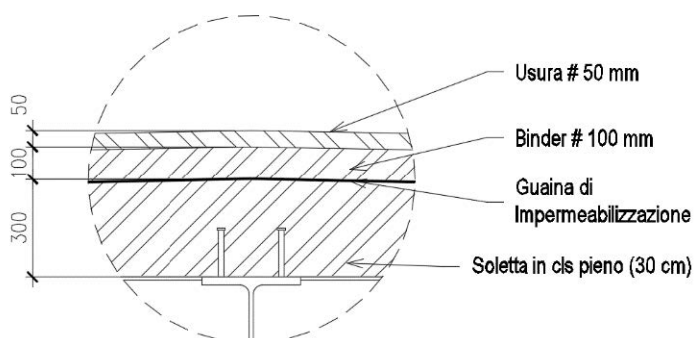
Dettaglio pacchetto soletta in calcestruzzo pieno
